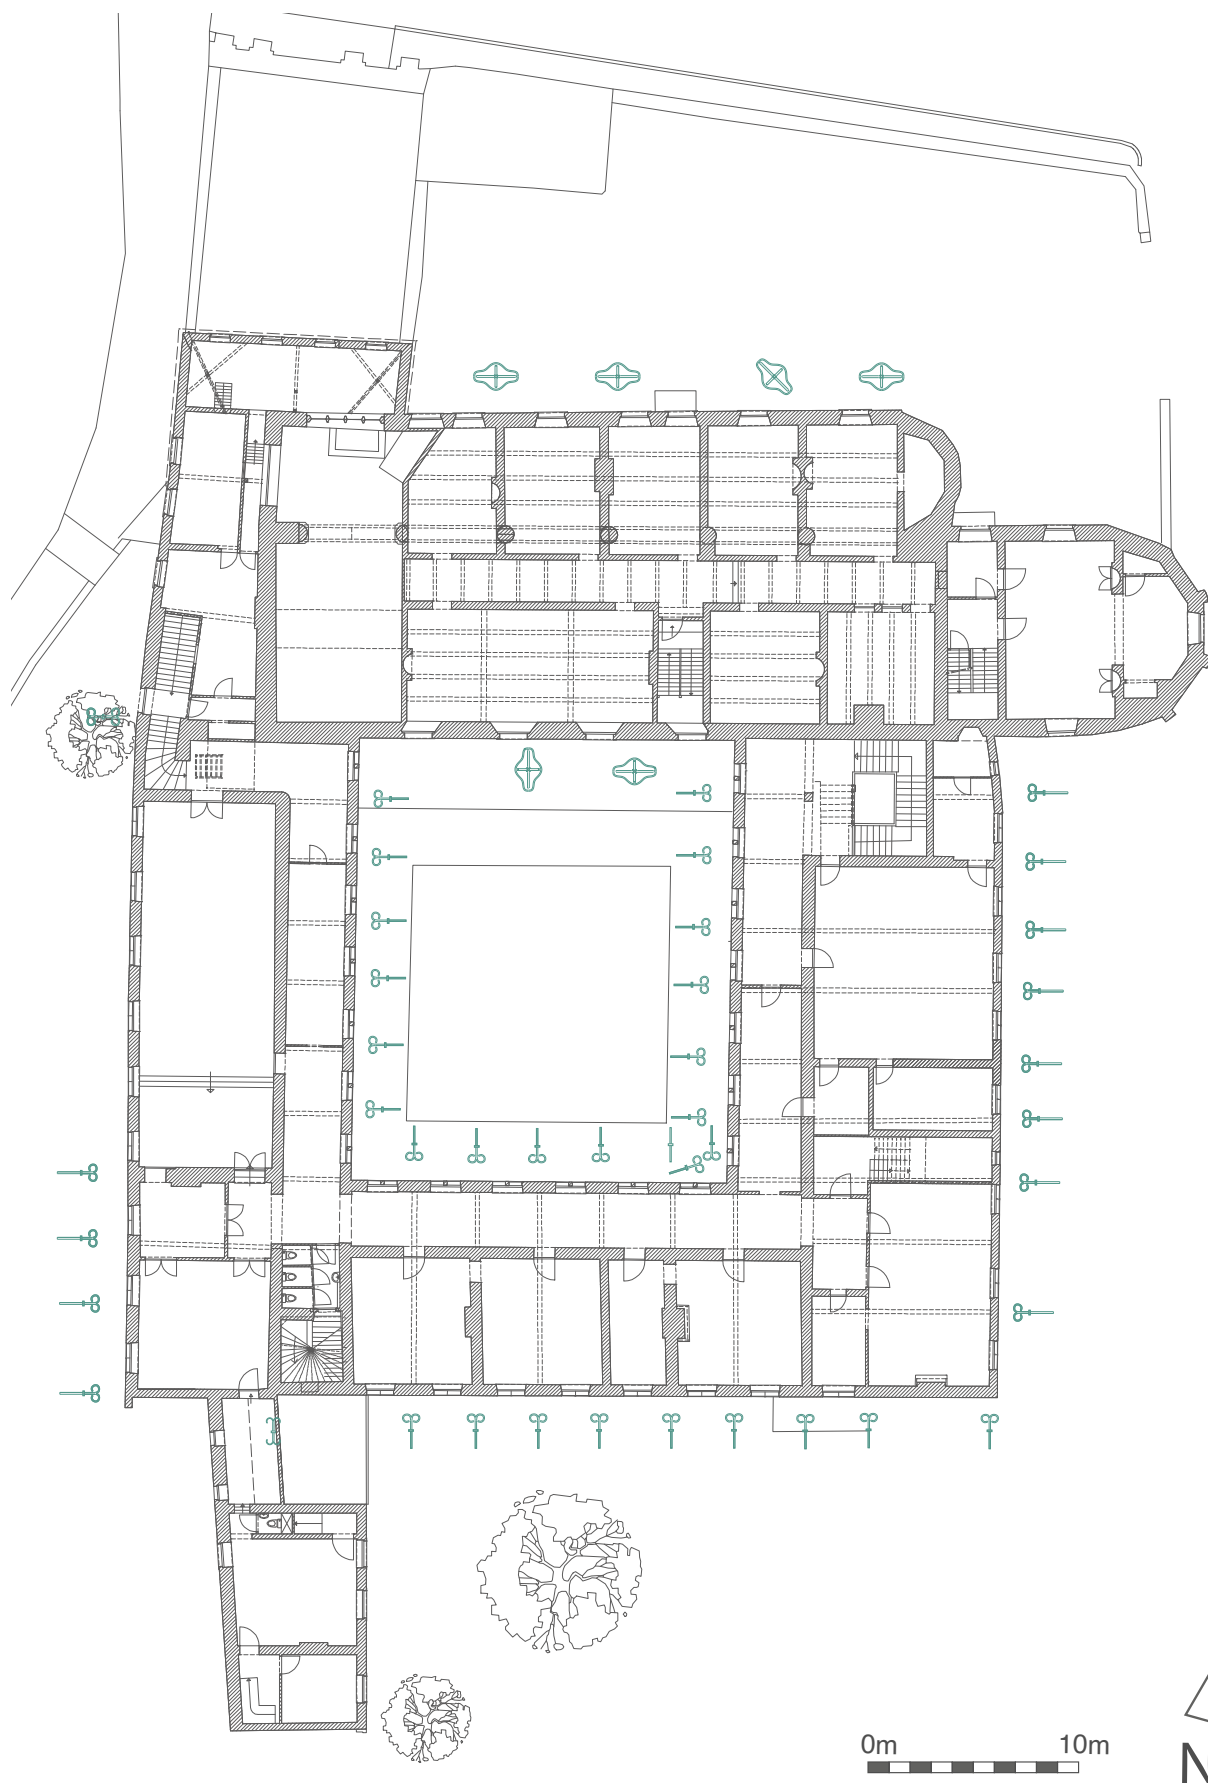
Plan de l'étage de l'ancien couvent - repérage des ancrs de façade se rapportant aux poutres du couvrant de l'étage.
